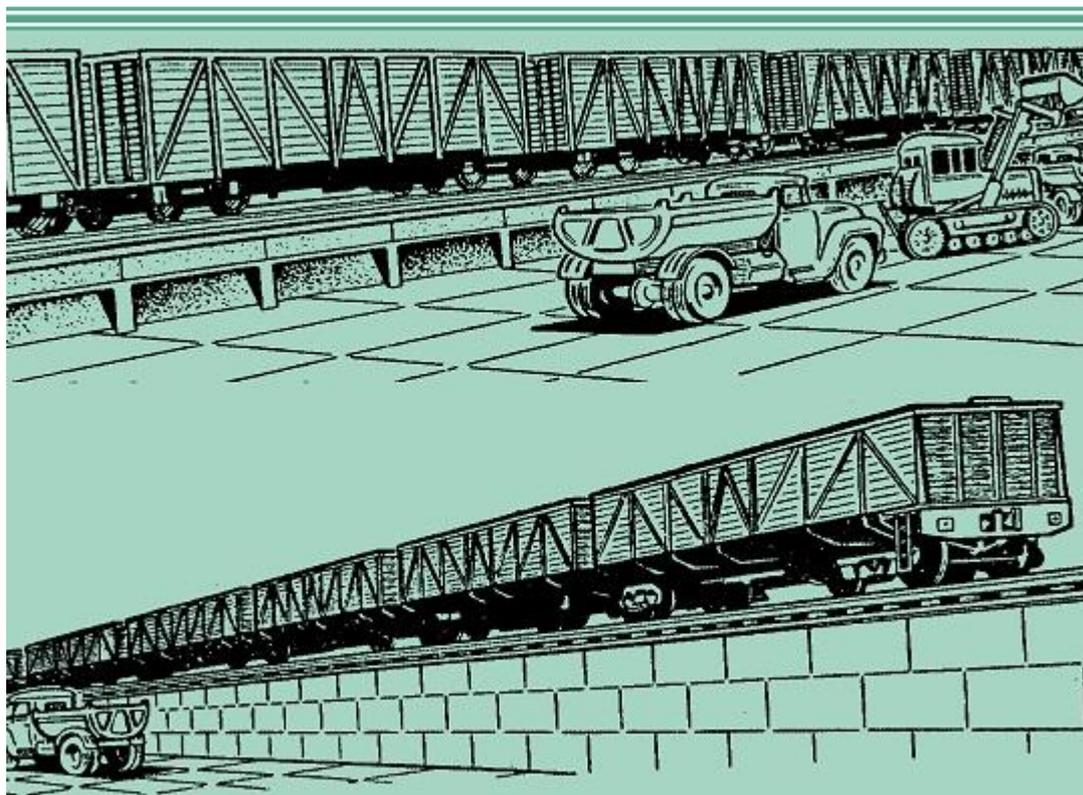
Повышенный путь (для выгрузки полувагонов): а — балочного типа; б — блочного типа
